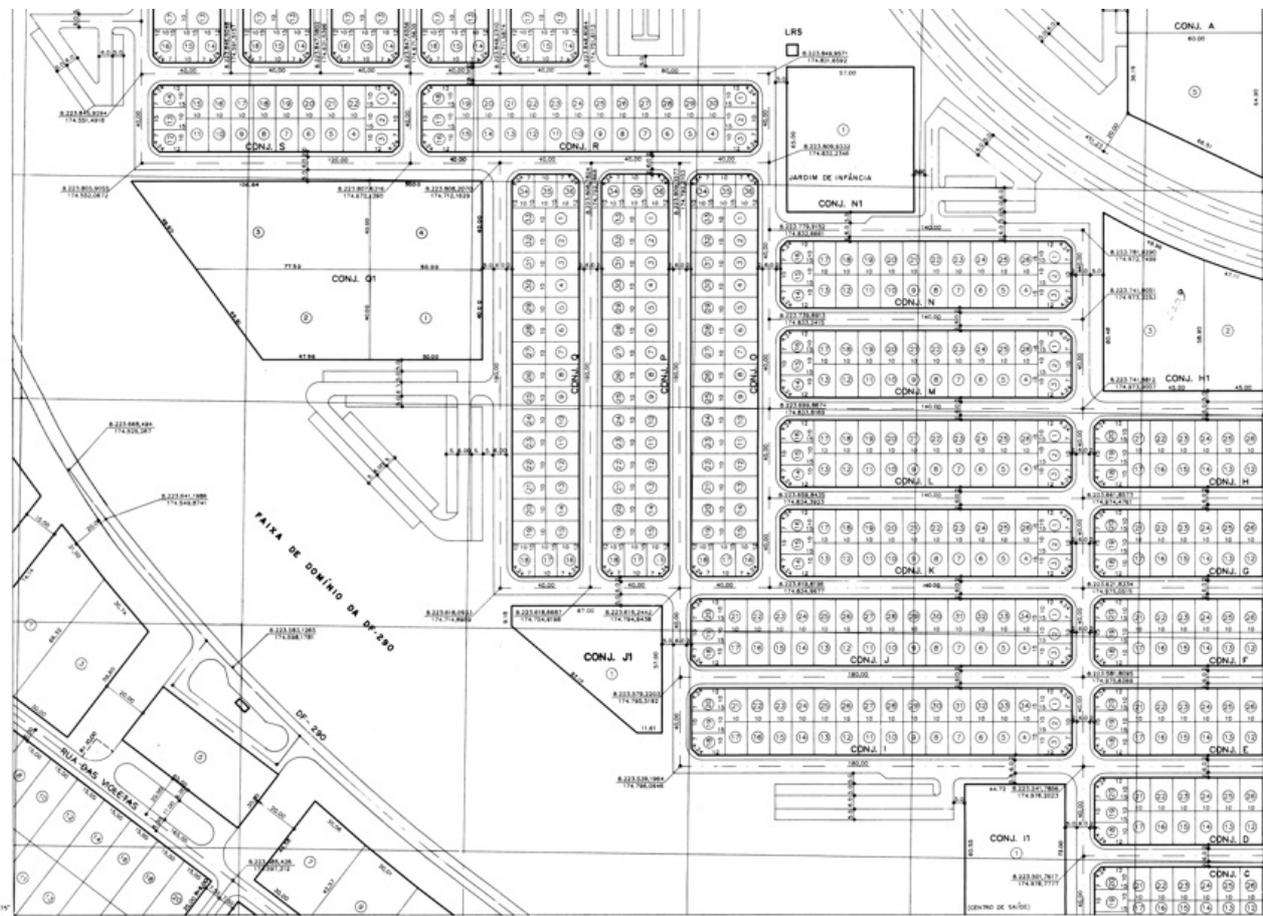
Recorte do Projeto de Urbanismo – URB 162/91 – Folha 06/06 - SICAD 232-I-3-A, área objeto desta DIREQ 16/2023. Fonte. Mapoteca/SEDUH.
